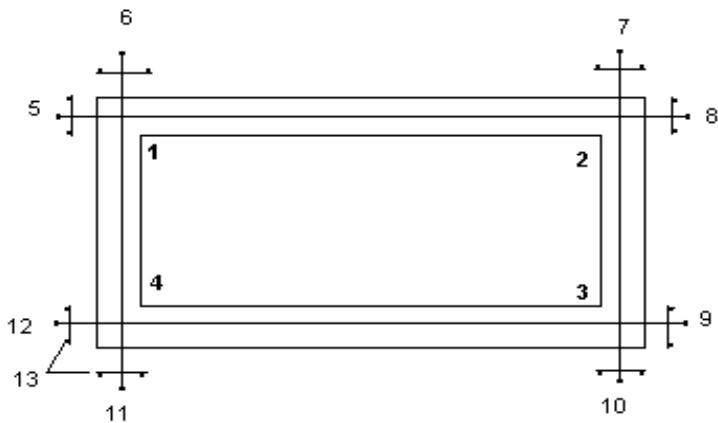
Схема закріплення осей будівлі або споруди на місцевості:
